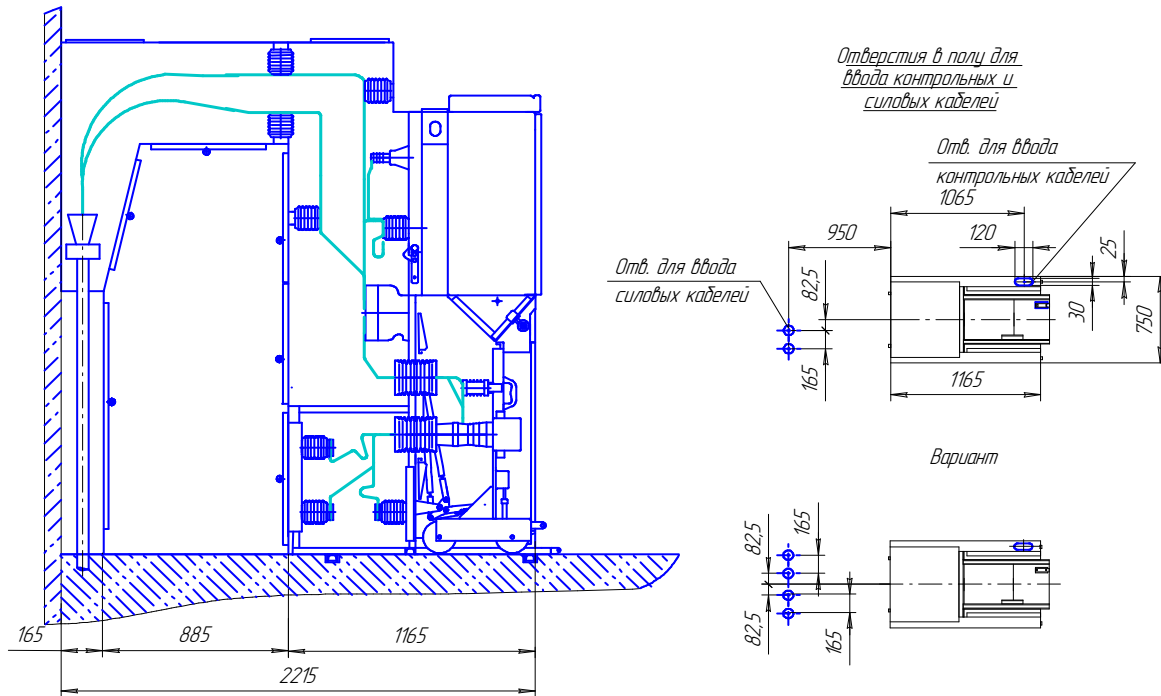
Установка шкафа с кабельным вводом снизу вне шкафа на фундамент
